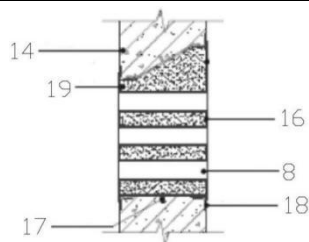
穿墙管群与混凝土侧墙之间的连接关系结构示意图
